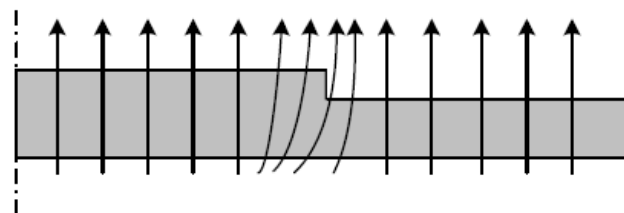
Ponte térmica em parede em zona de alteração da espessura de parede
